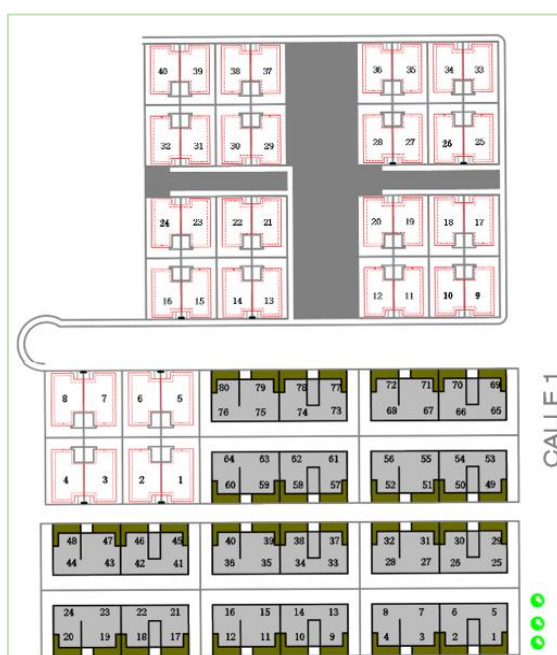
Micro localización de las viviendas conjunto Nuevo Jaramijó
